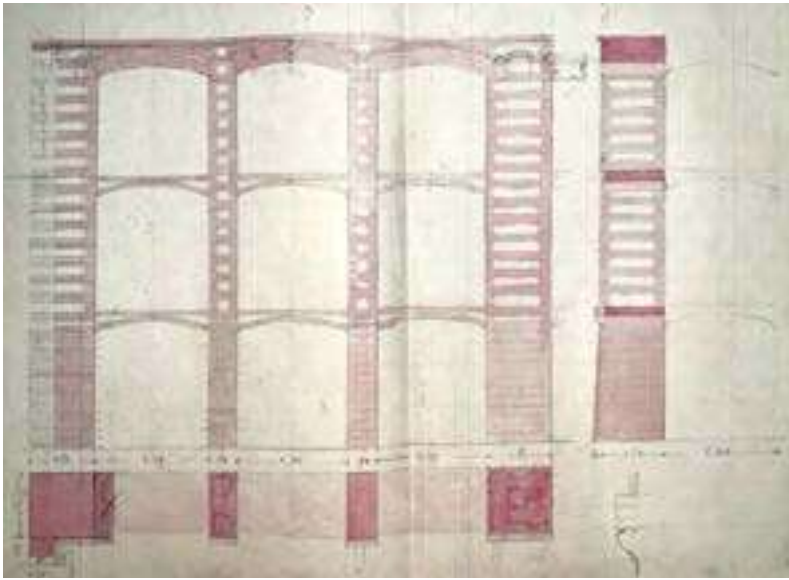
Muro di sostruzione del transetto ovest della chiesa di Sant'Eusebio, disegno di Progetto, (Crescentino Caselli), pianta, prospetto e sezione (ASCC, Culto).
